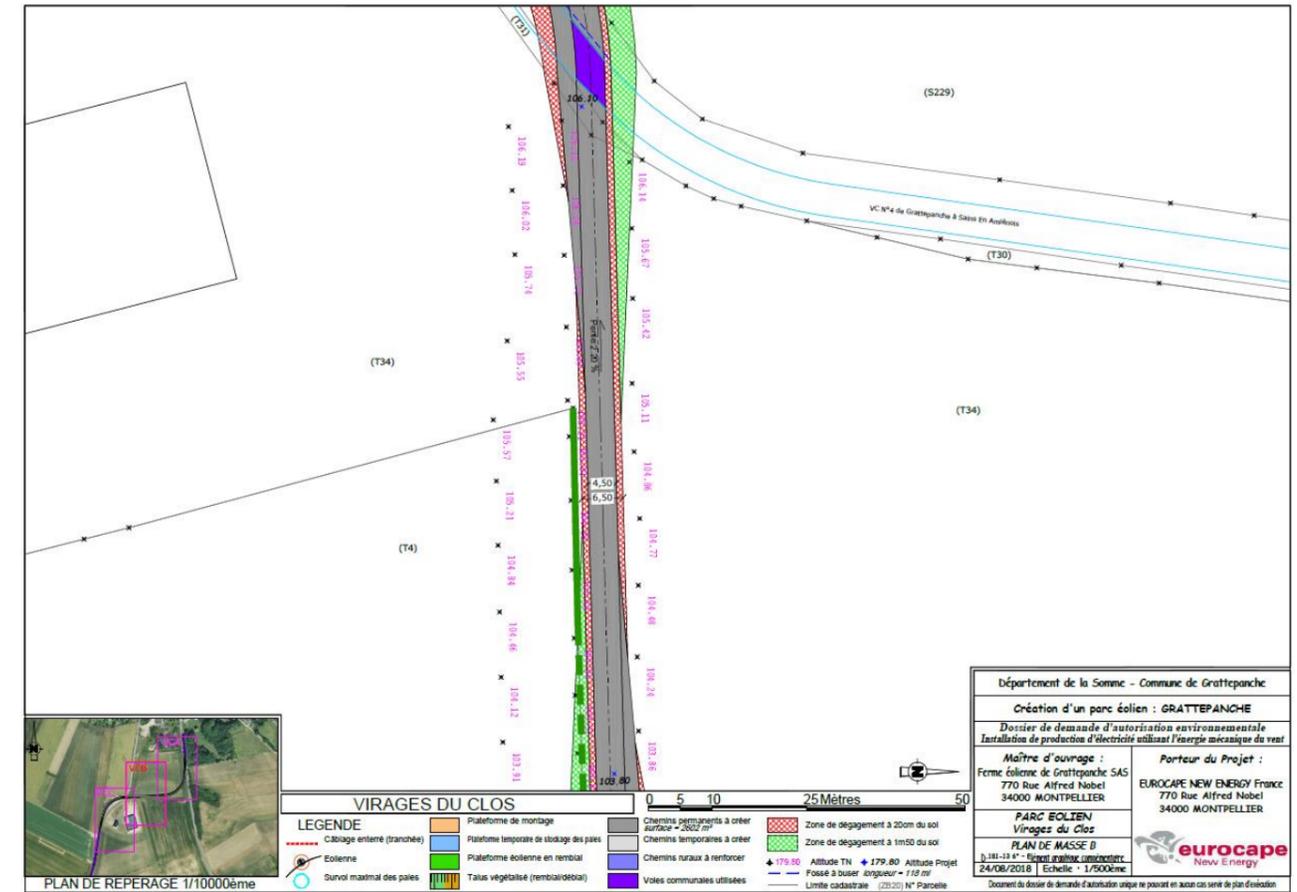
Plan aux 1/500ème disponible en page 34 de la pièce n°3
